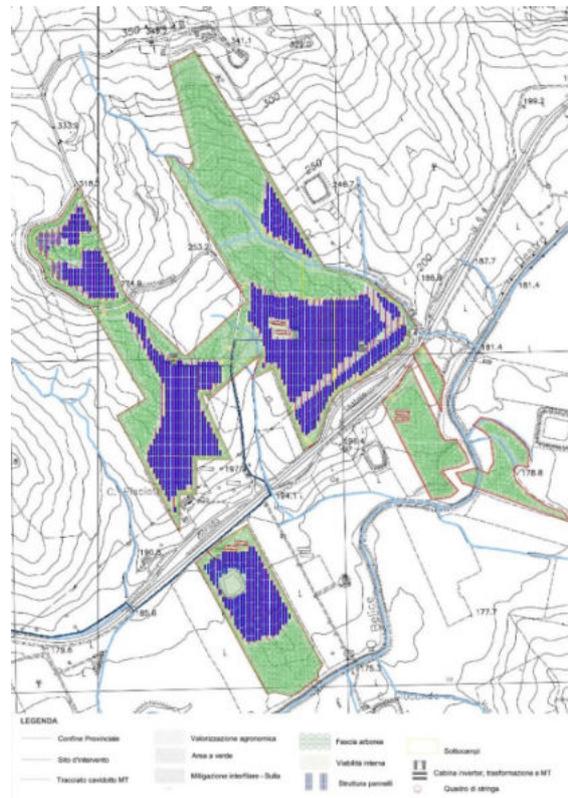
B – Layout dell'impianto ricadente in Contrada Torretta con cavidotto
